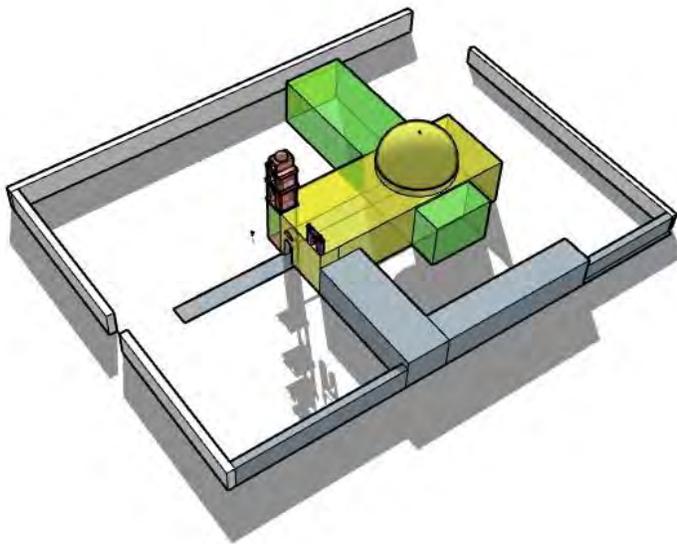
Volumetría general del templo parroquial de San Juan Bautista, Epatlán.* Elaboración propia (2018).
